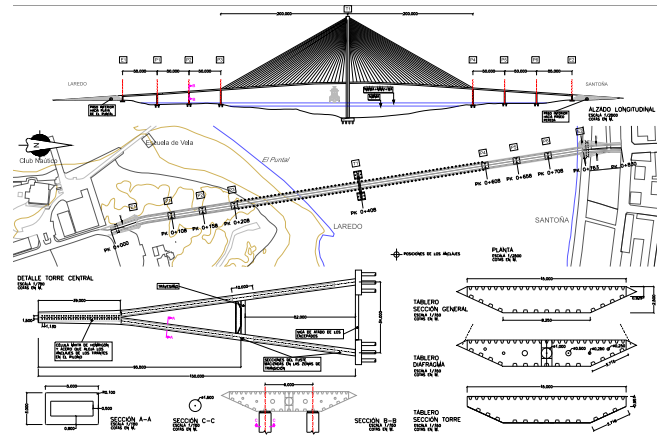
Alternativa TP4, puente atirantado con doble plano de tirantes.
